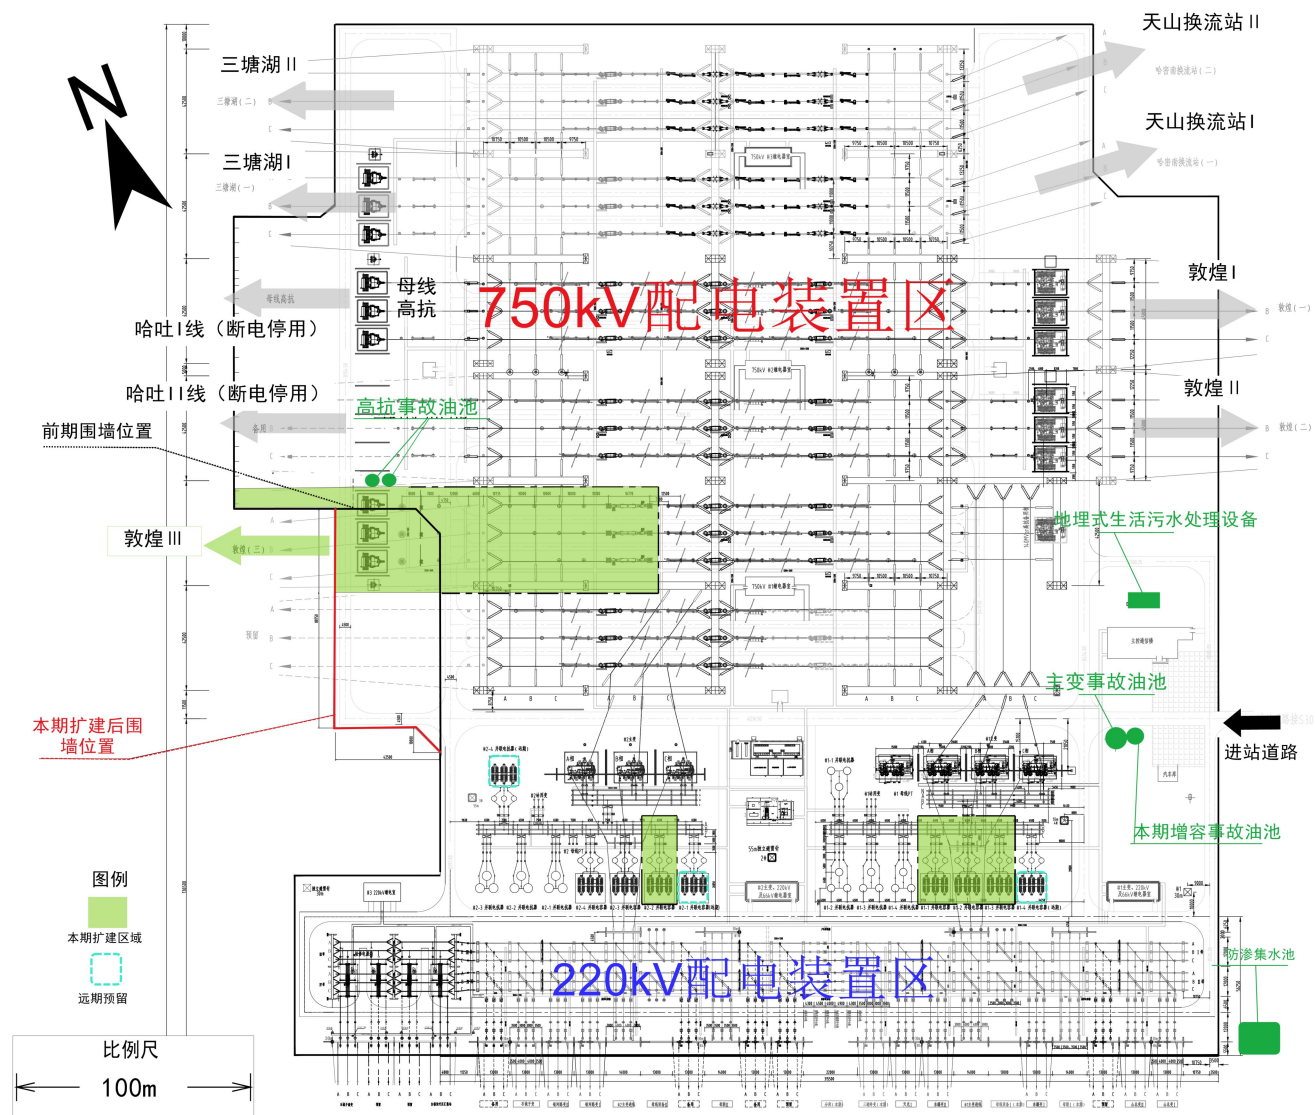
哈密 750kV 变电站总平面布置图
